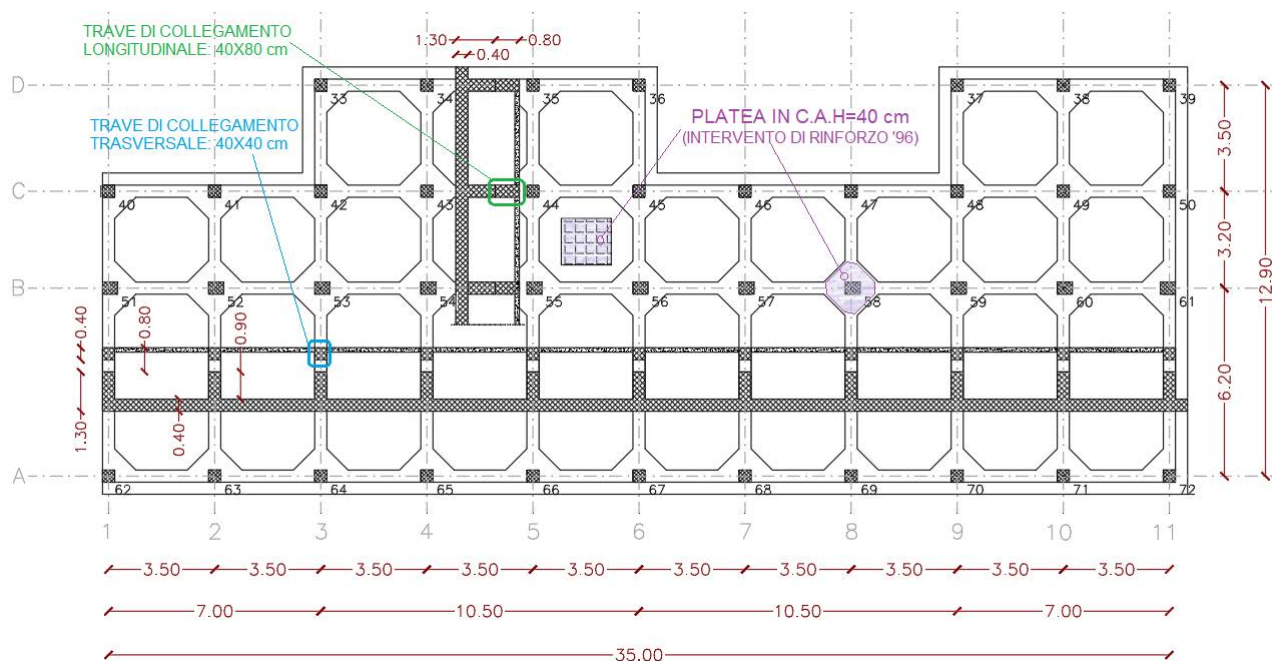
STATO DI FATTO: STRALCIO DELLA PIANTA DI FONDAZIONE DEL BLOCCO B
